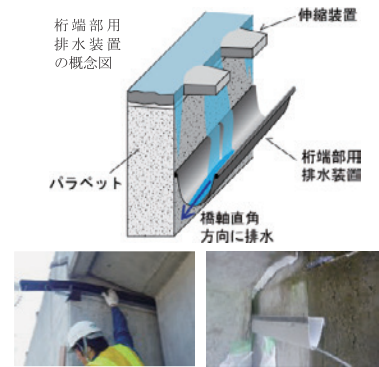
コンクリート橋桁端部の狭い遊間に設置可能な排水装置の提案、試験施工
